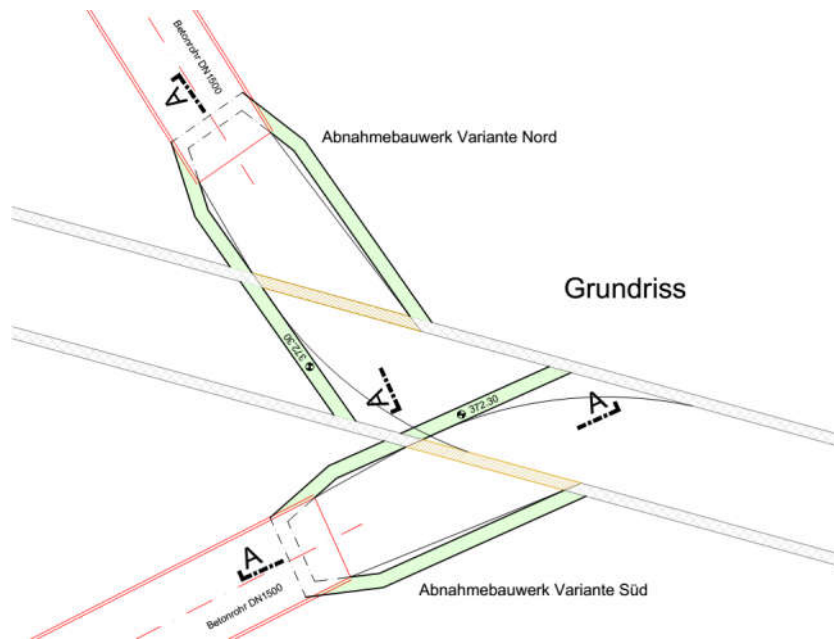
Auszug Plan 104 Abnahmebauwerk
